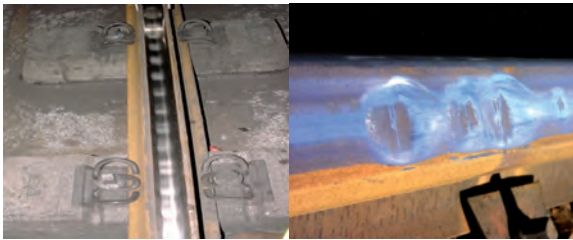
Usure ondulatoire sur une section de rail (à gauche) et défauts locaux de surface (à droite) (source RATP)
